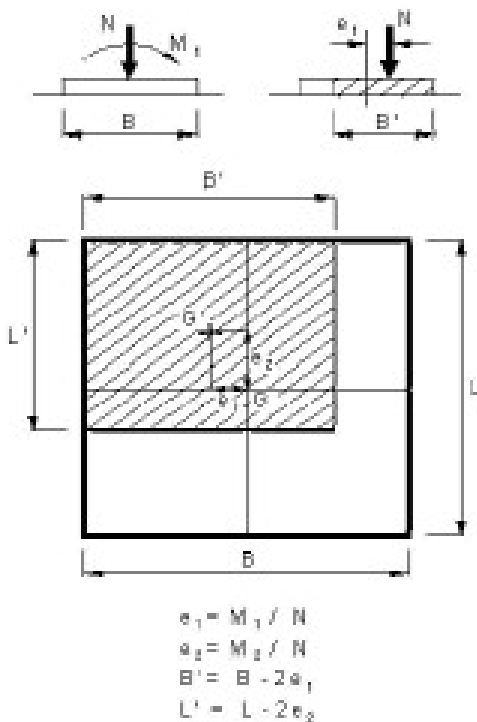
Fondazione efficace equivalente nel caso di fondazione rettangolare
